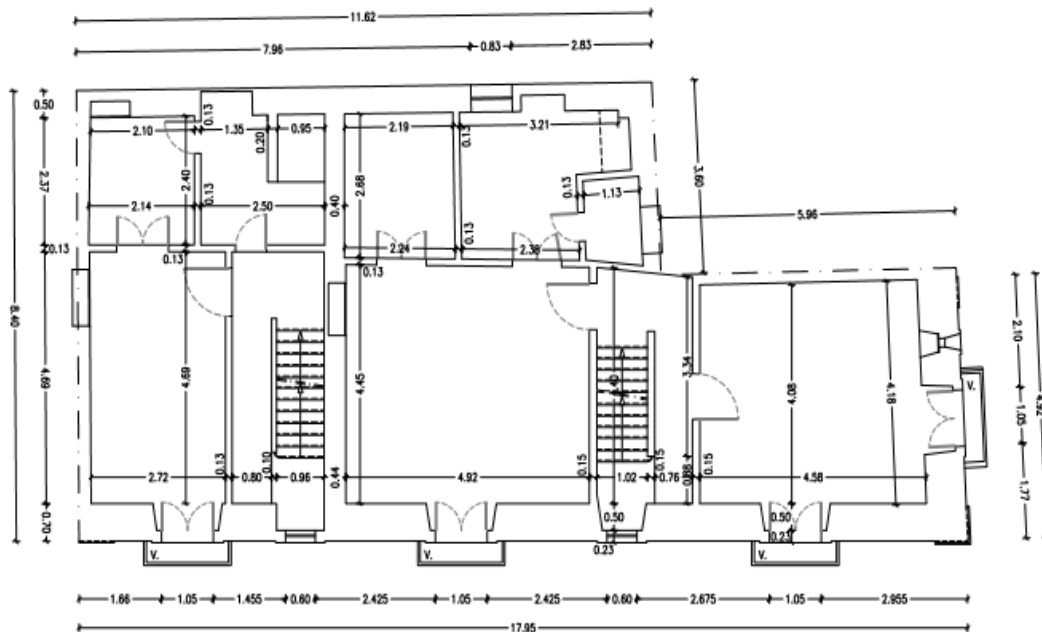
Planta do Piso 1 existente (Fonte: Projeto de Arquitetura)
